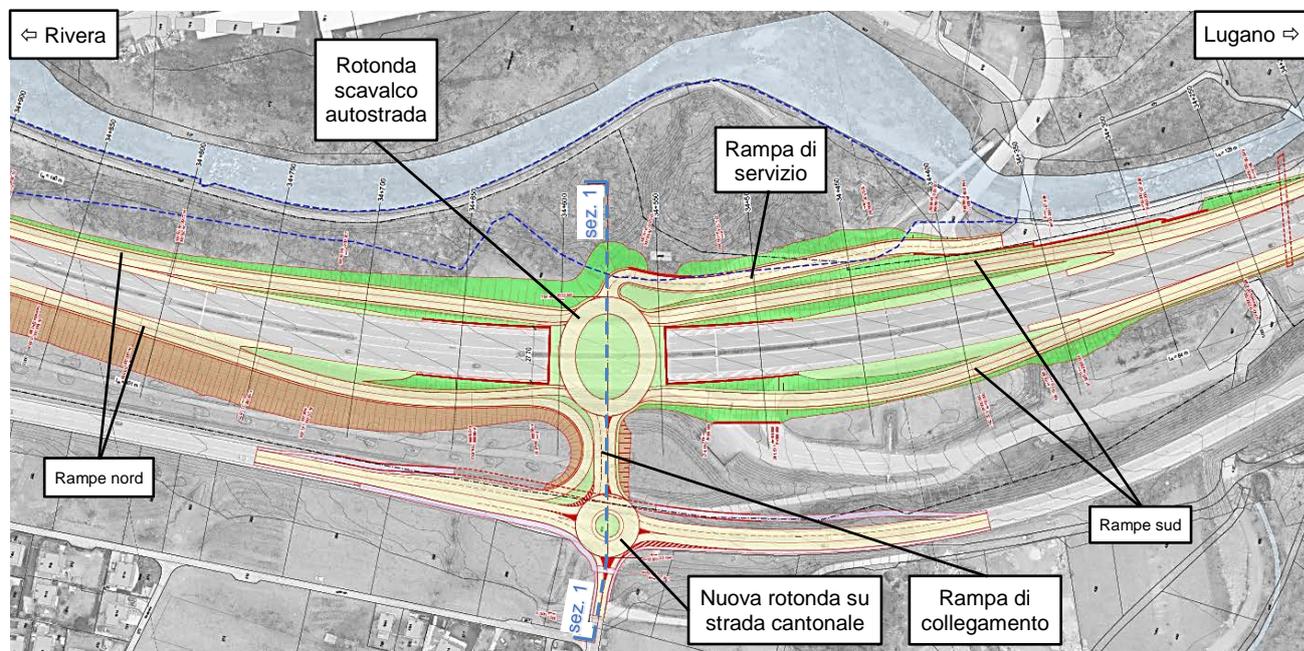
planimetria dello svincolo autostradale a diamante con la rotonda ovoidale di scavalco all'autostrada e la nuova rotonda all'incrocio con la strada cantonale. Le rotonde sono unite da una rampa di collegamento e, verso il fiume Vedeggio, vi è la rampa di servizio.
